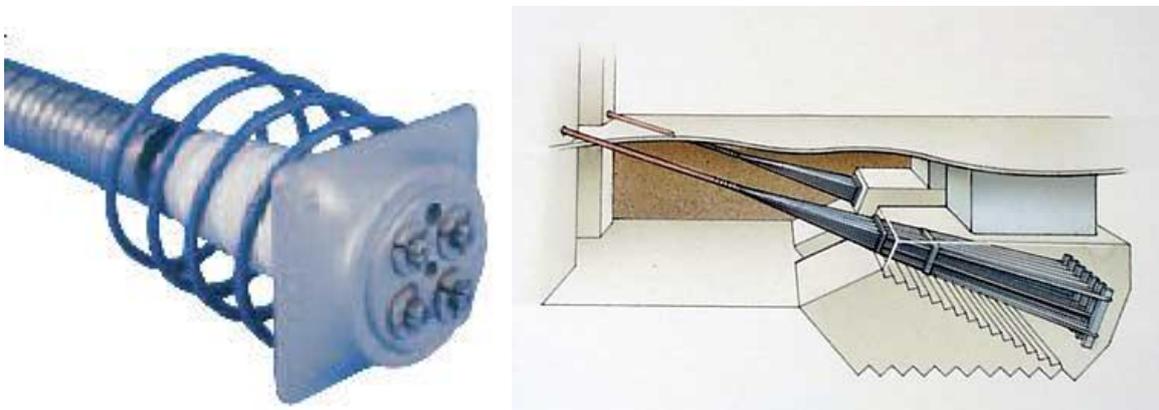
Sistemas de anclaje al suelo por medio de muertos de hormigón
